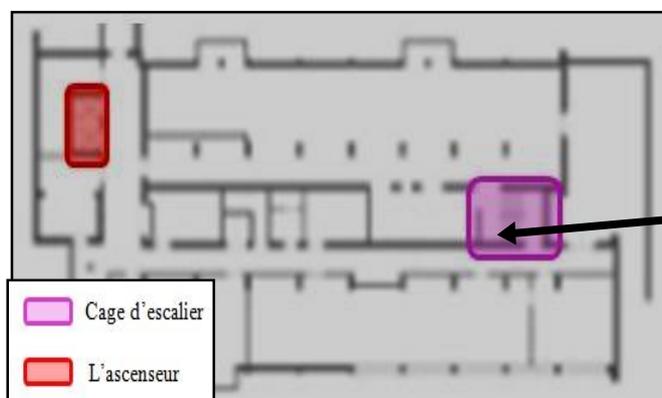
Plan du RDC, Bâtiment A (CUG)
